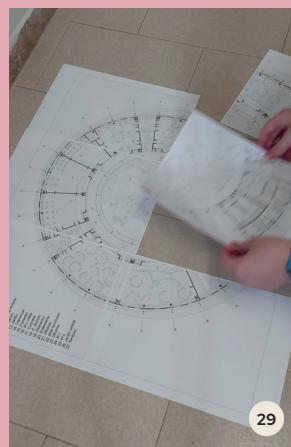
Detalhe da colagem das paredes. Fonte: Acervo pessoal.
